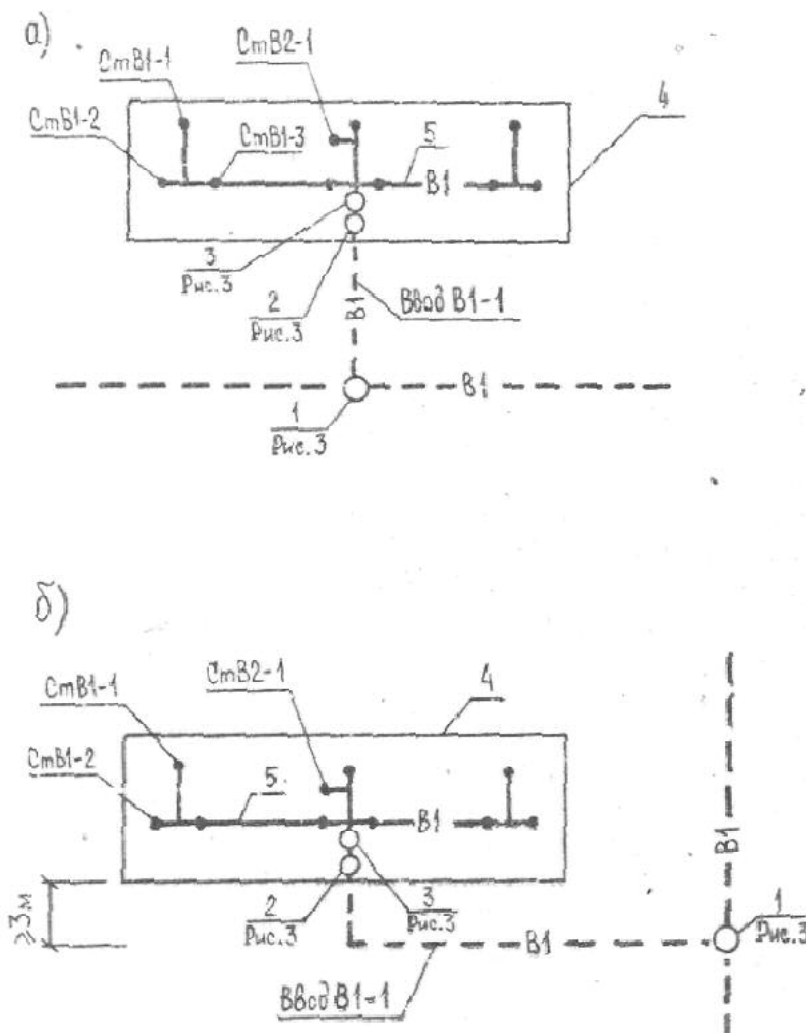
Пример устройства ввода водопровода в здание: а/ 1-й вариант генплана; б/ 2-й вариант генплана; 1 - узел подключения к наружной сети; 2 - водомерный узел; 3 - насосная установка; 4 - контур техподполья здания; 5 - разводящая сеть
